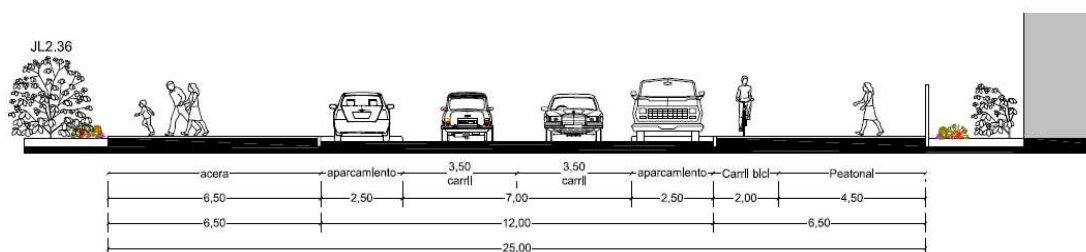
Sección transversal de viales previstos para los sectores de ordenación
